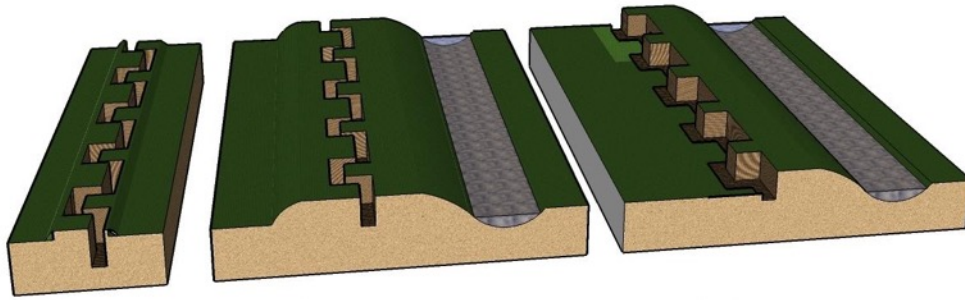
Doorsnede van de loopgraaf met weergave van de mogelijke borstweringen. Vijandelijke zijde is rechts. Links zonder borstweringen (a), midden met zowel parapet als parados (b), rechts met enkel de parapet (c) (Afbeelding uit: [Stichelbaut 2009](#))
